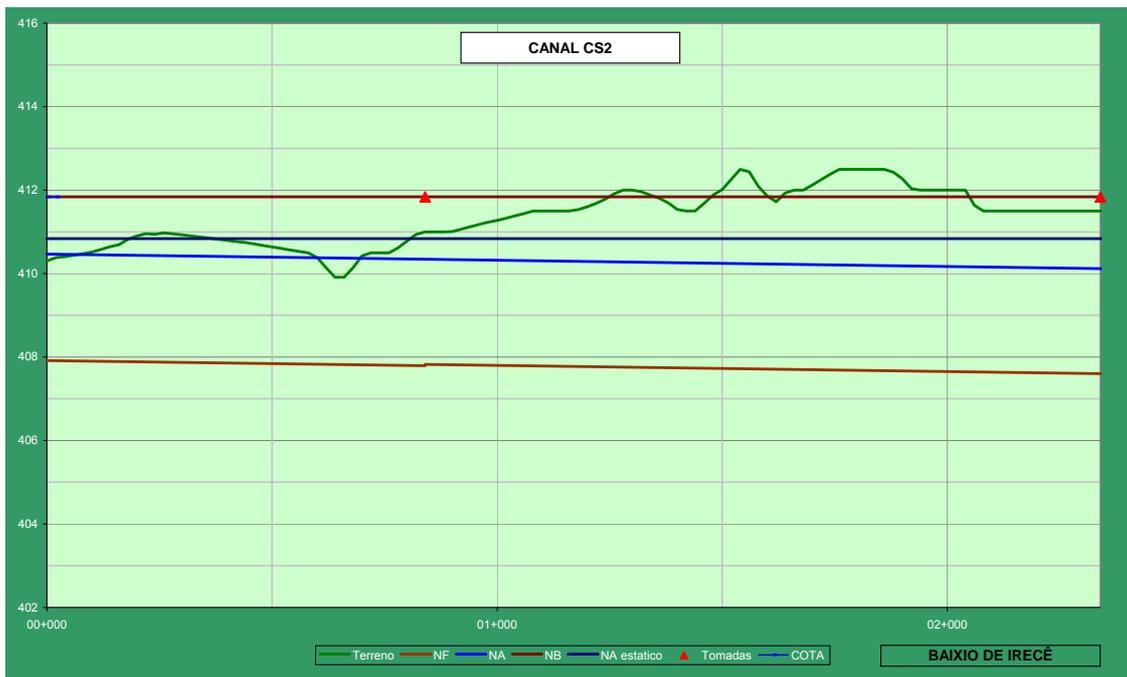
Perfil Longitudinal do Canal Principal CS-02
